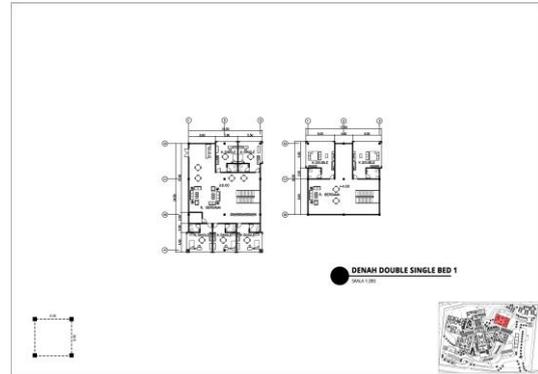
Denah Massa Utama Lantai 1 dan 3
